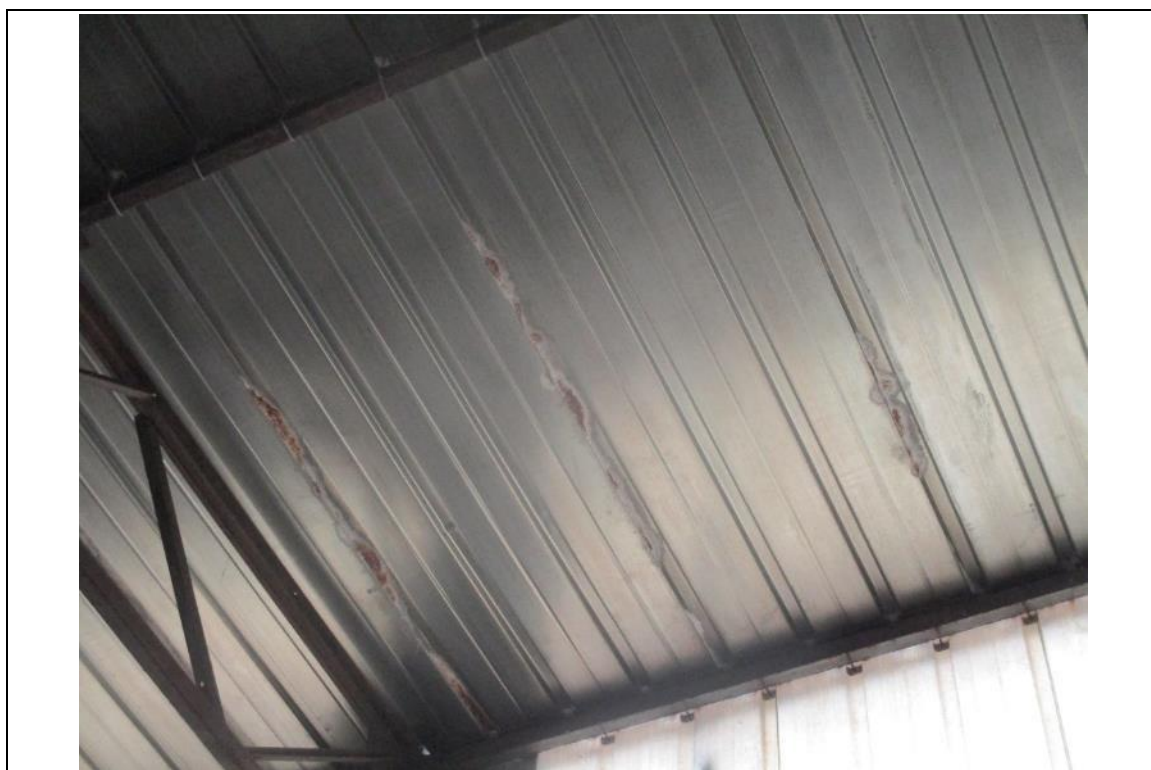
Corrosion - Côté Est, au droit du local 012 entre B11 et A16
